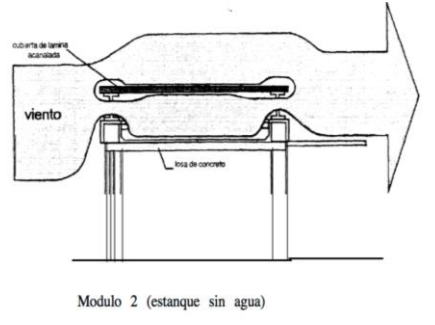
Módulo 2, sin techo estanque, con cubierta fija y ventilado
